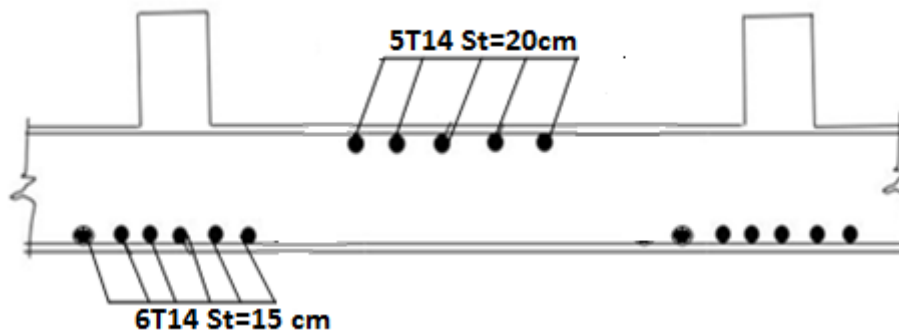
Schéma de ferrailage de la dalle du radier (sens yy)
